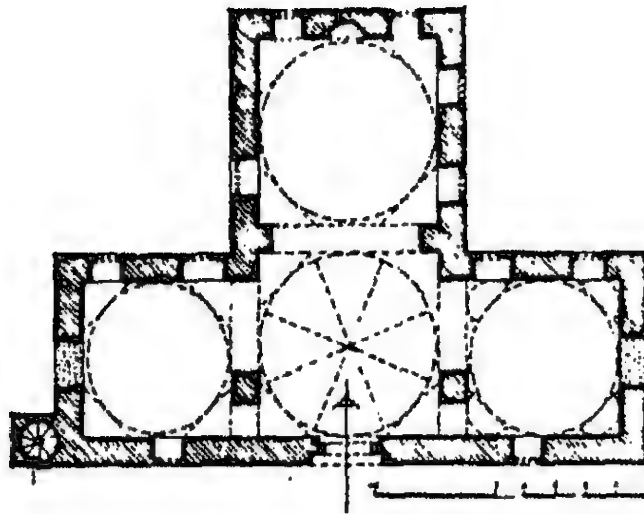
مسقط أفقي لمسجد غازي ميخال في أدرنة (عن : اصلان ابا)
